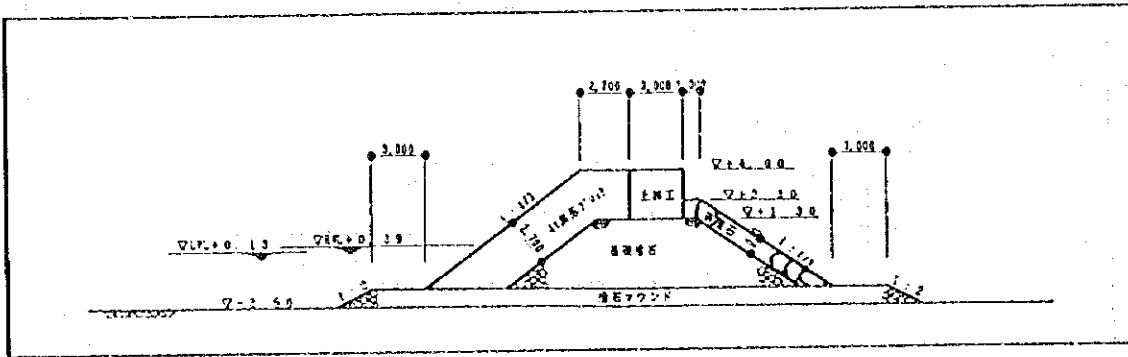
防波堤堤幹部の標準断面図（不透過構造）
